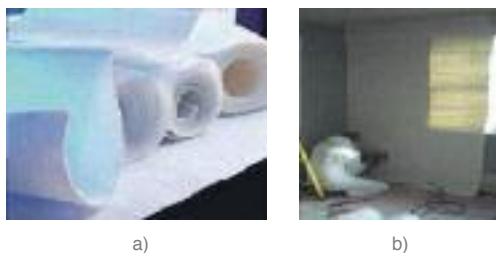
a) Exemplo de manta flexível para isolamento térmico; b) Aplicação da manta em obra.
